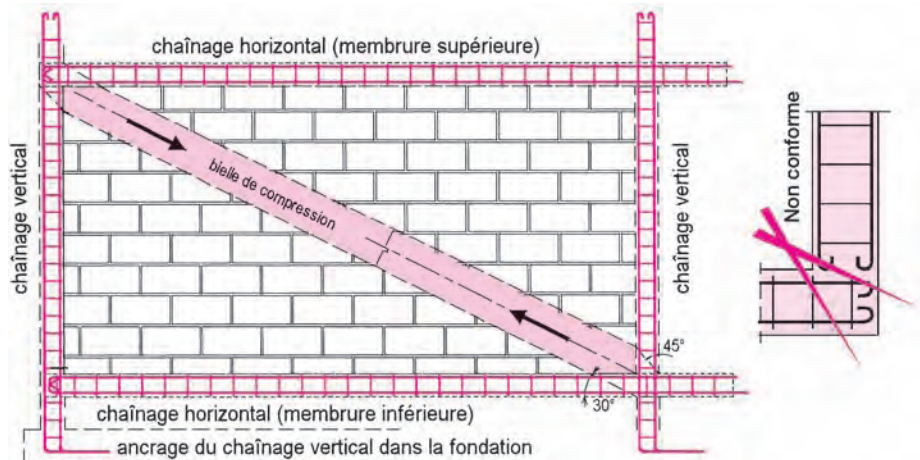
Ceintures par chaînages dans les plans horizontal et vertical d'une maison
